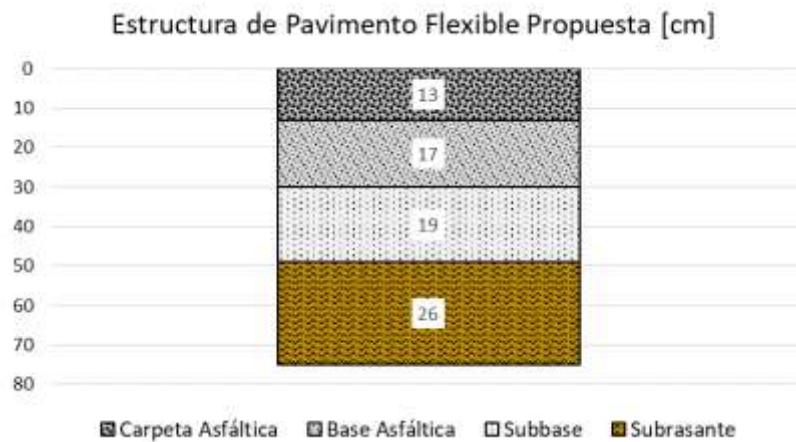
Estructura de Pavimento Flexible Propuesta
